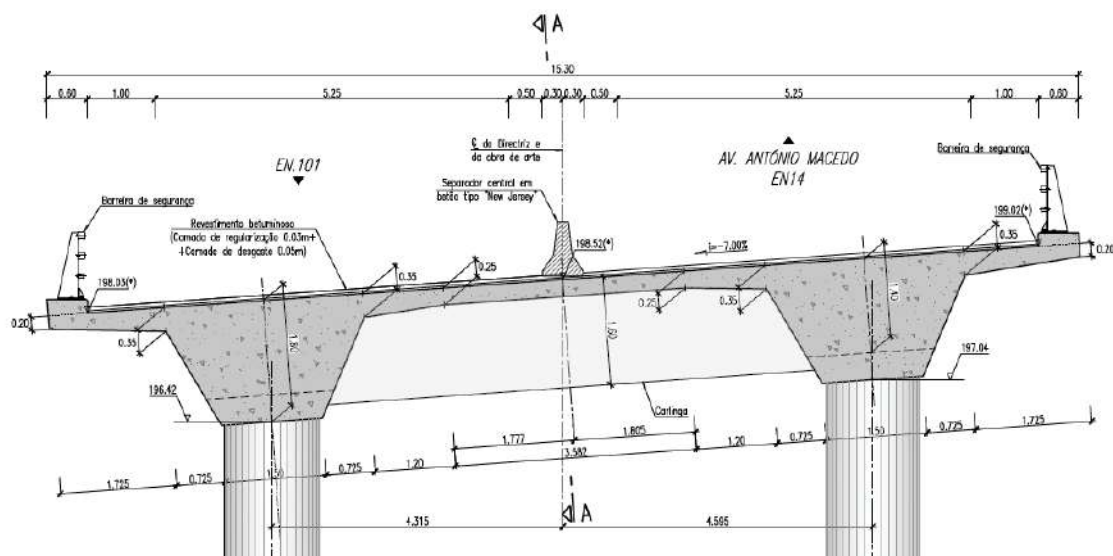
Corte tipo no tabuleiro junto ao apoio (Pilares P4 e P5).
